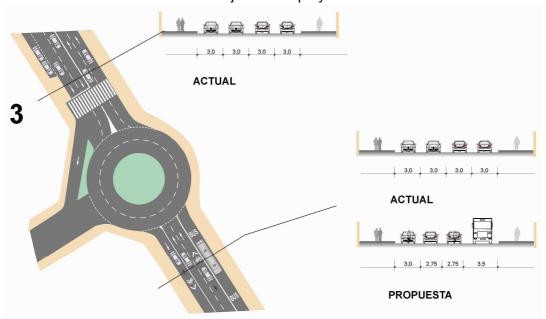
Sección y planta propuesta en C. Ribera del Loira (altura C. Tomás Redondo).
